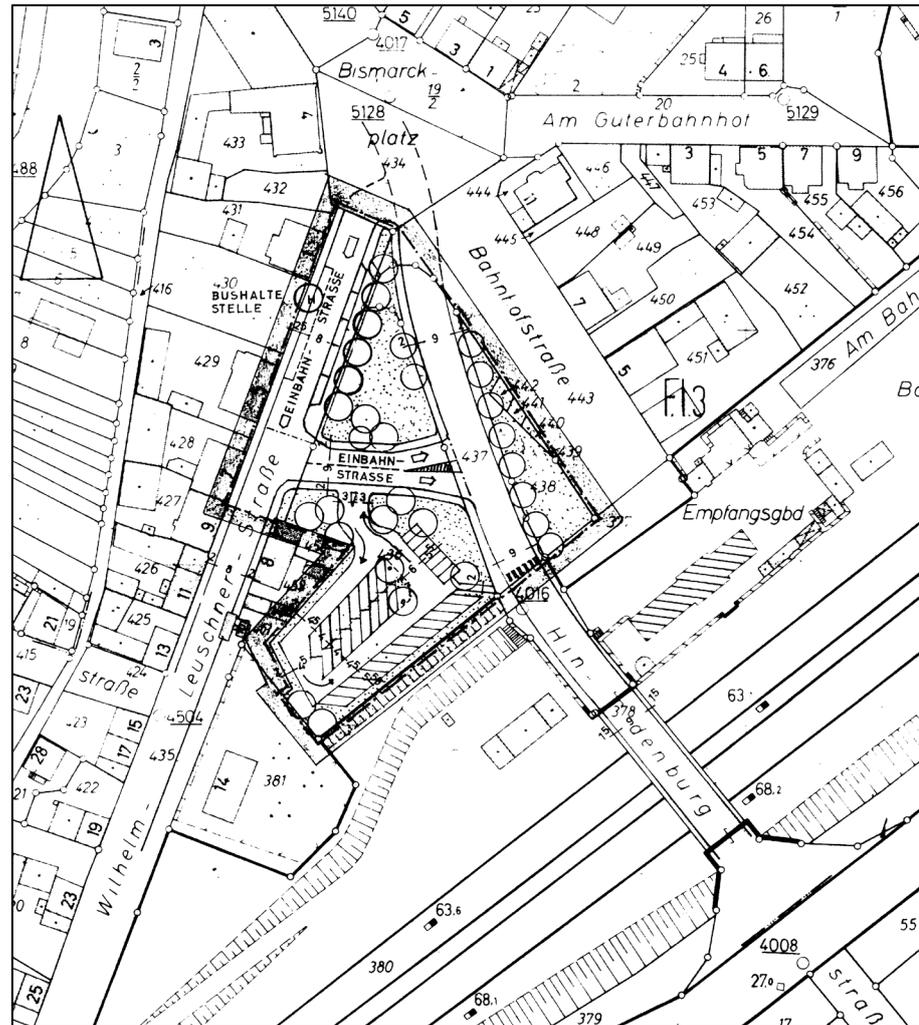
Bebauungsplan „Im Riemen“ 2. Änderung (Änderungsbereich markiert)
